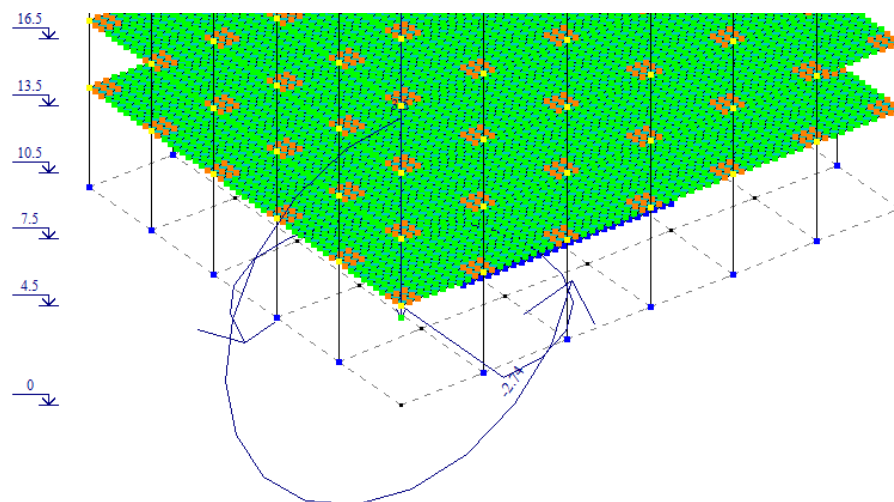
Фрагмент приложение нагрузки на удаляемую колонну.
